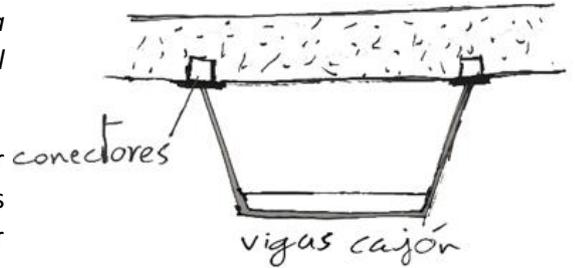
Esquema estructura mixta en vigas cajón. Elaboración propia.
